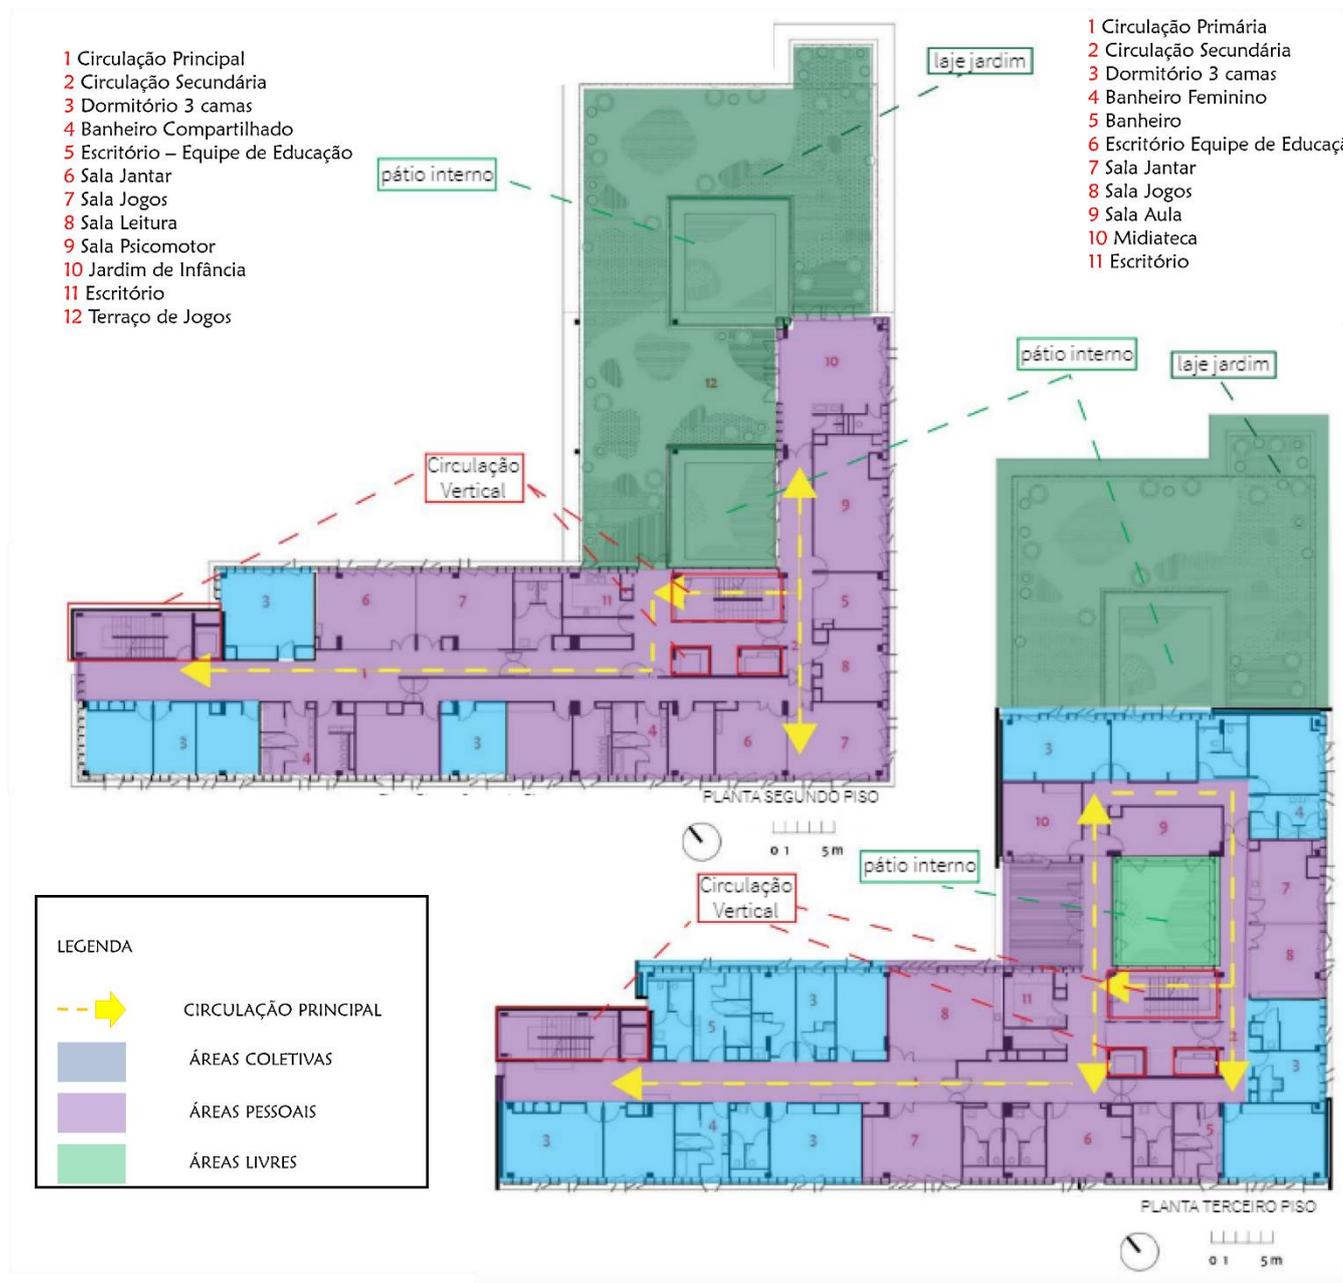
Estudo Projetual. Plantas Segundo e Quarto Pavimento.
